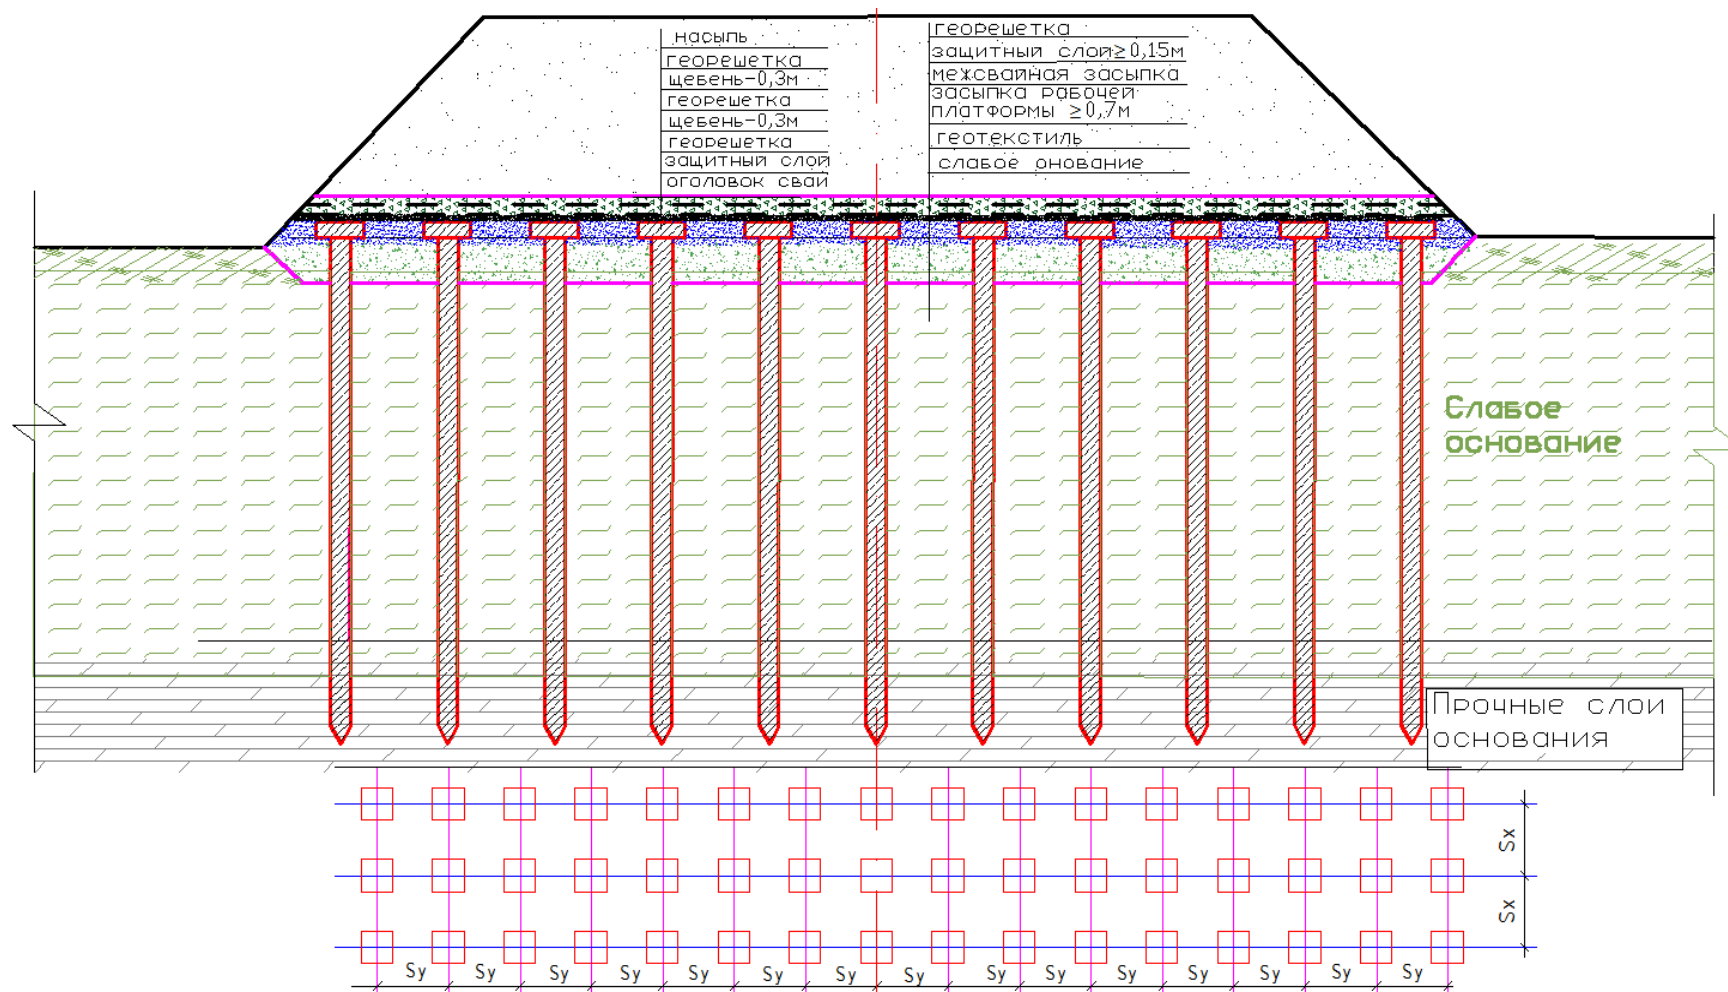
Гибкий ростверк из двух слоев георешетки со щебнем на железобетонных сваях с оголовками (с размещением свай по квадратной сетке)
